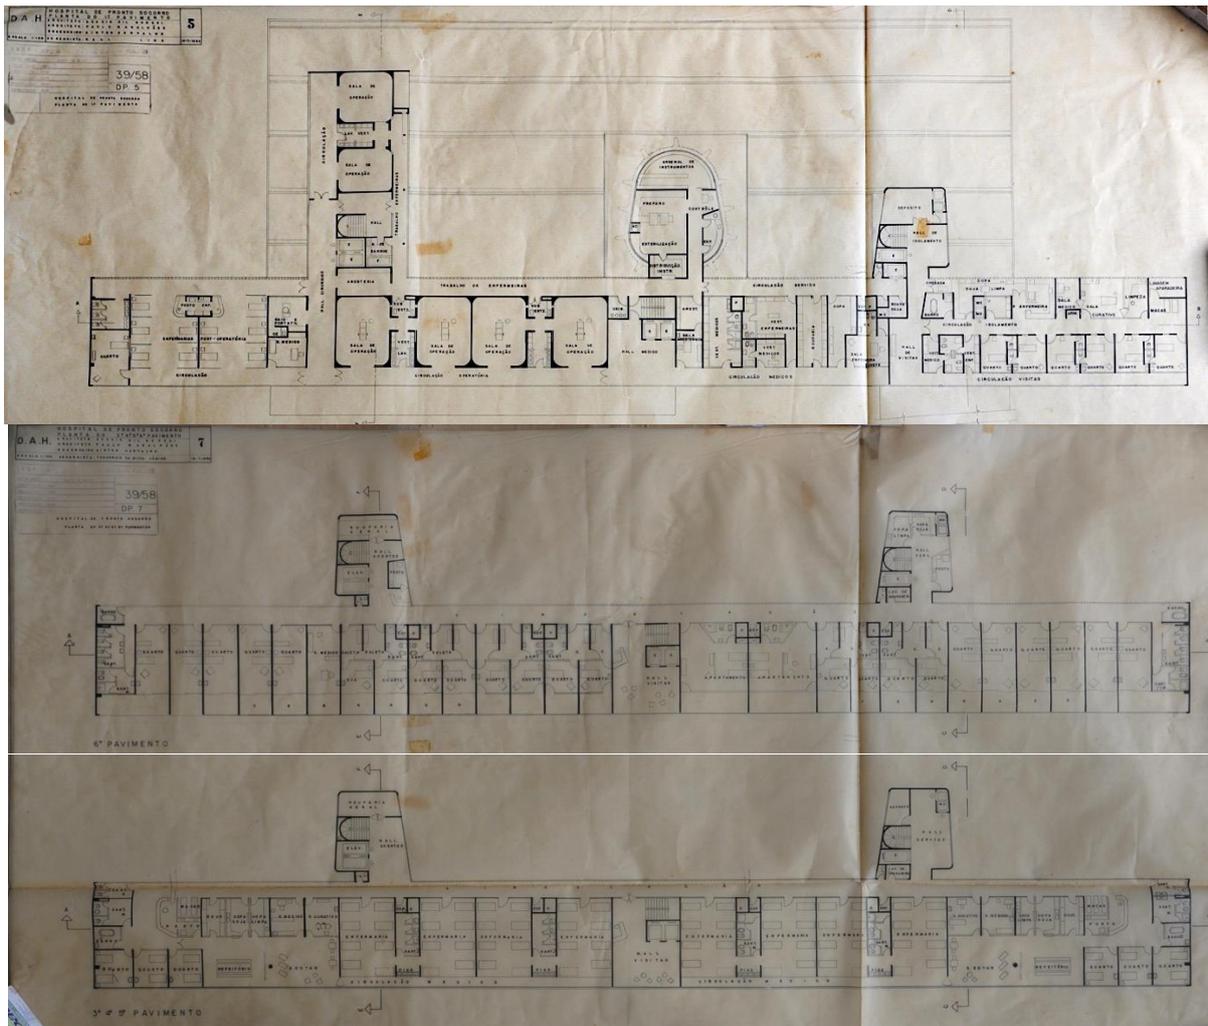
Projeto de 1953: (a) 1^o pavimento; (b) 3^o – 5^o pavimento; (c) 6^o pavimento. Fonte: Arquivo da SSEPE.
